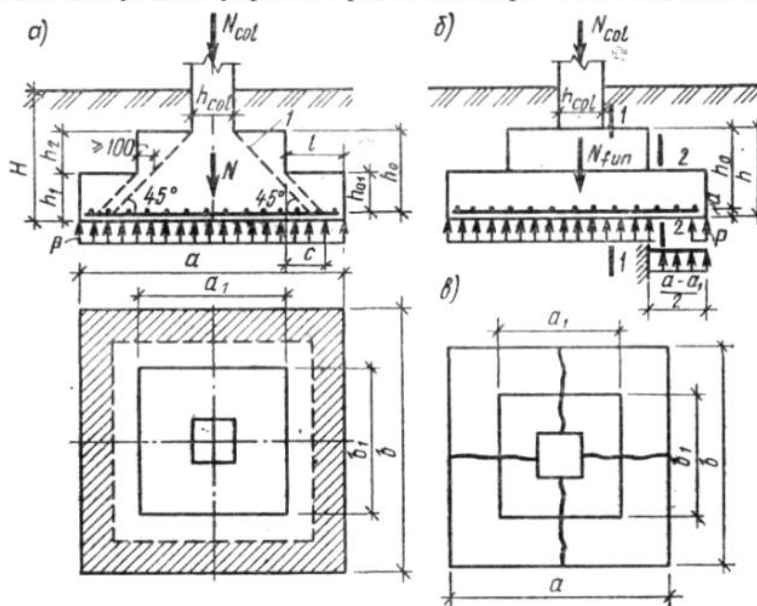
К расчету отдельных центрально нагруженных фундаментов:
